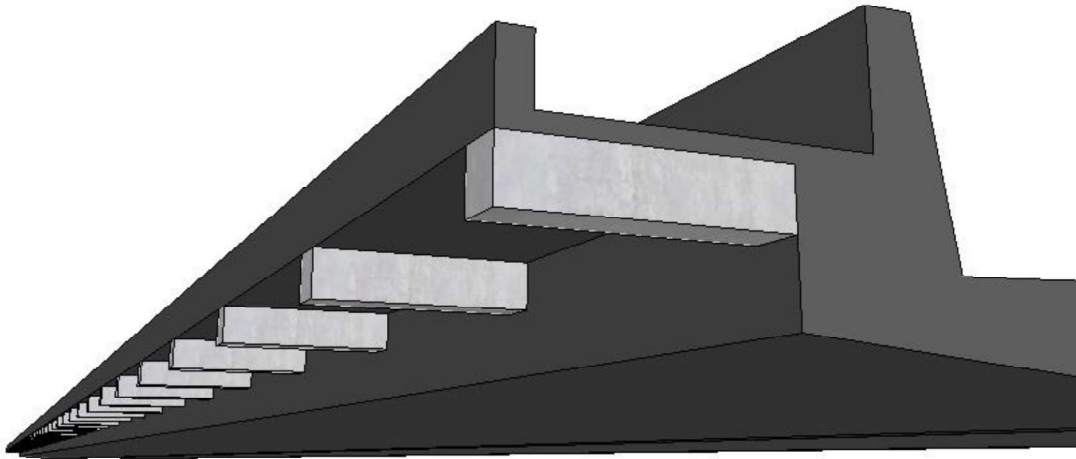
Representação das vigas longarinas e transversinas da ponte.
